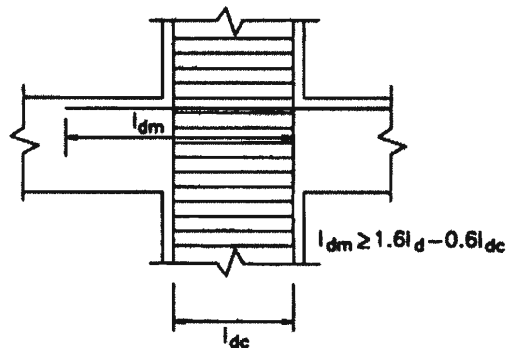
Anclaje del refuerzo longitudinal de vigas en los nudos
